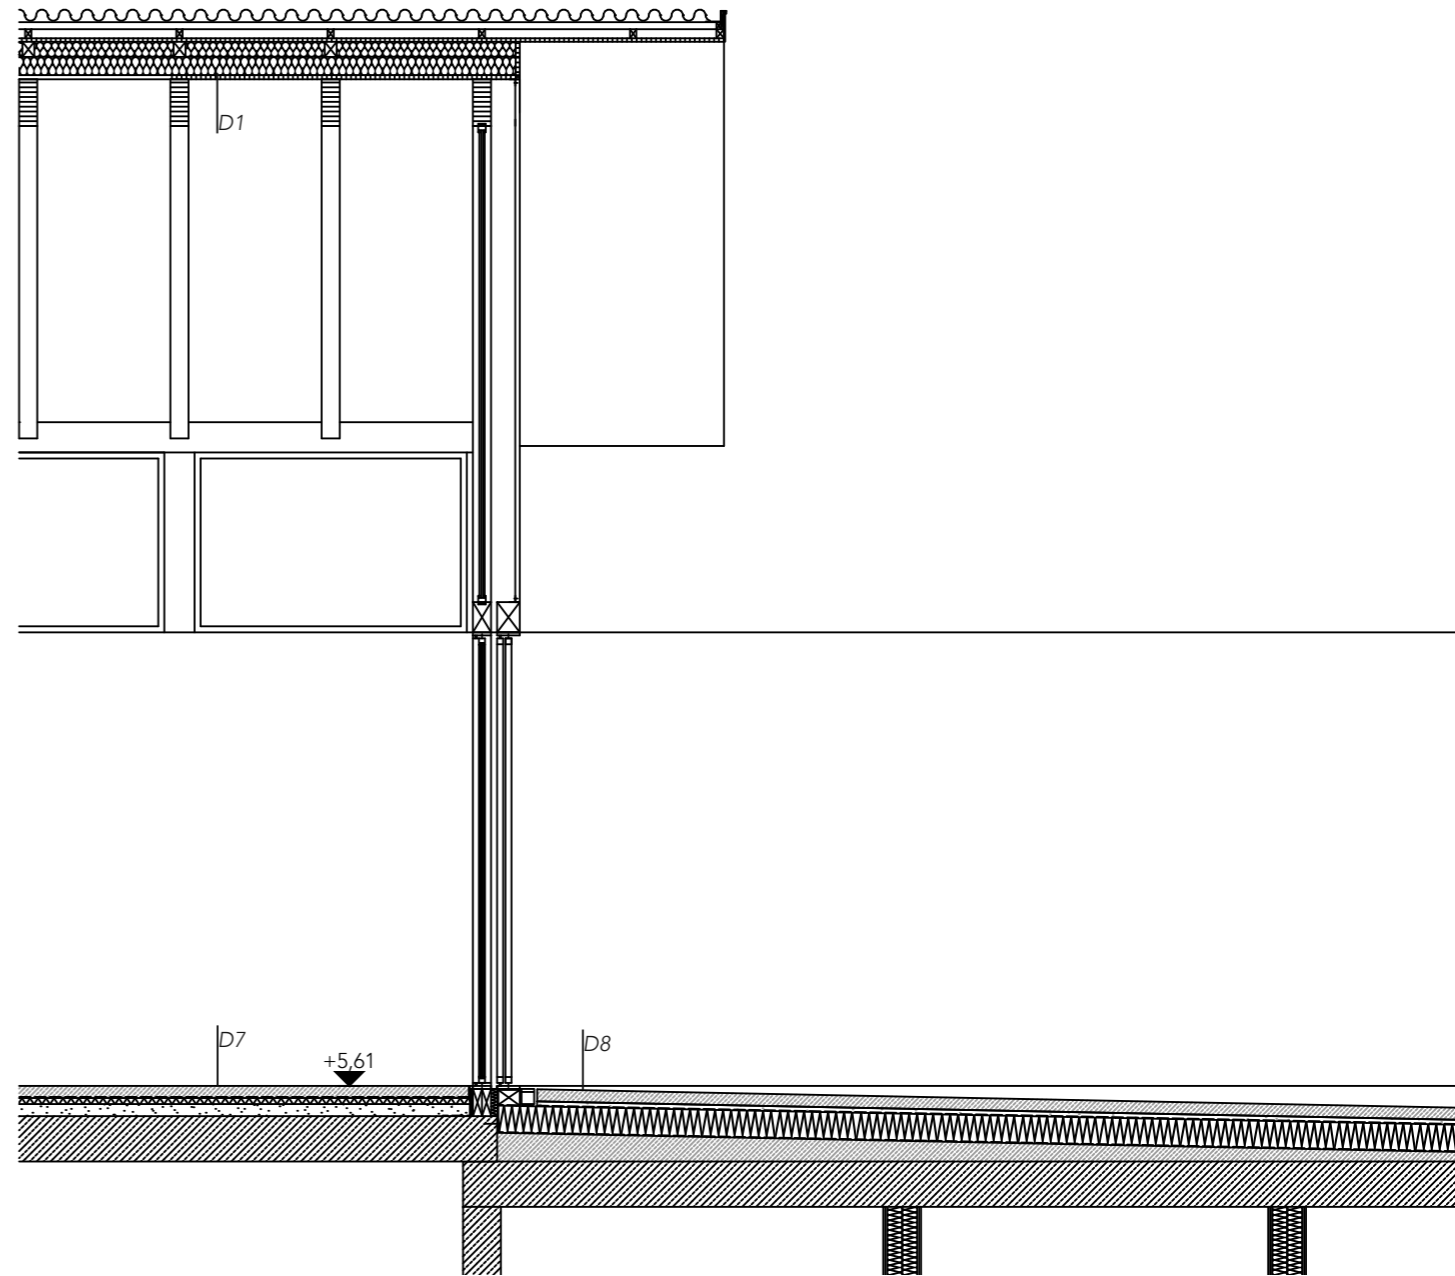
Fassadenschnitt Lokal Hof 2 M 1:50
